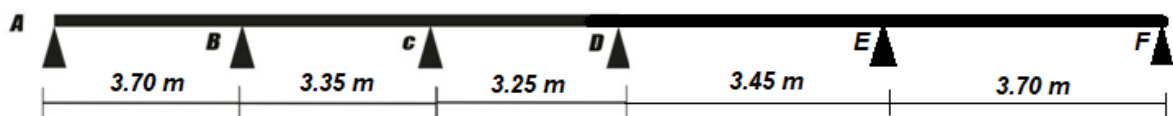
Schéma du 4^{eme} type de poutrelle.
